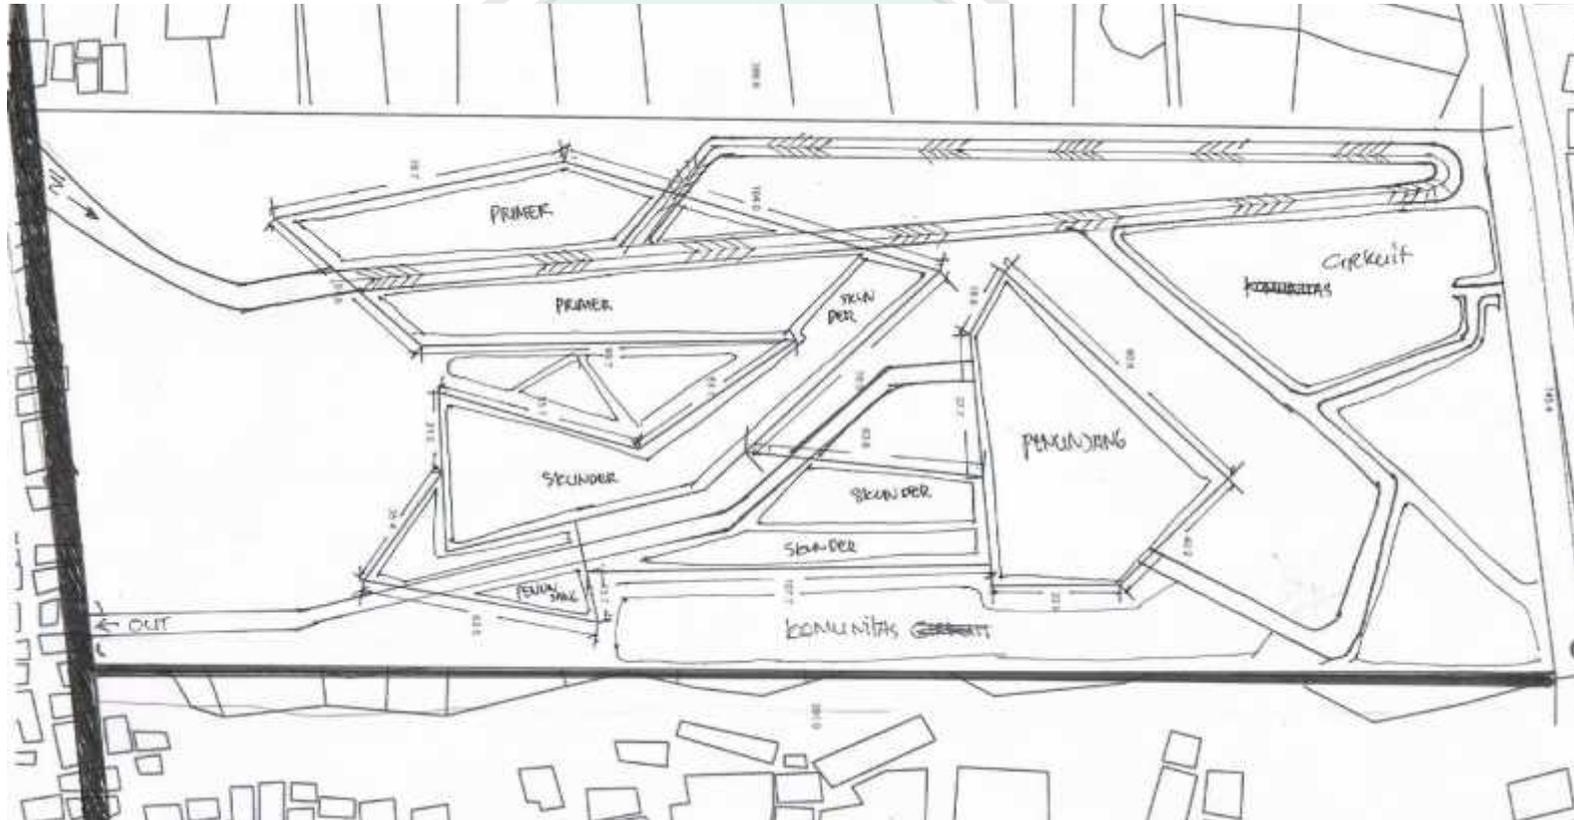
Alternatif blockplan zoning ruang dan bentuk tapak ke 1 (Sumber: Analisis pribadi, 2014)
